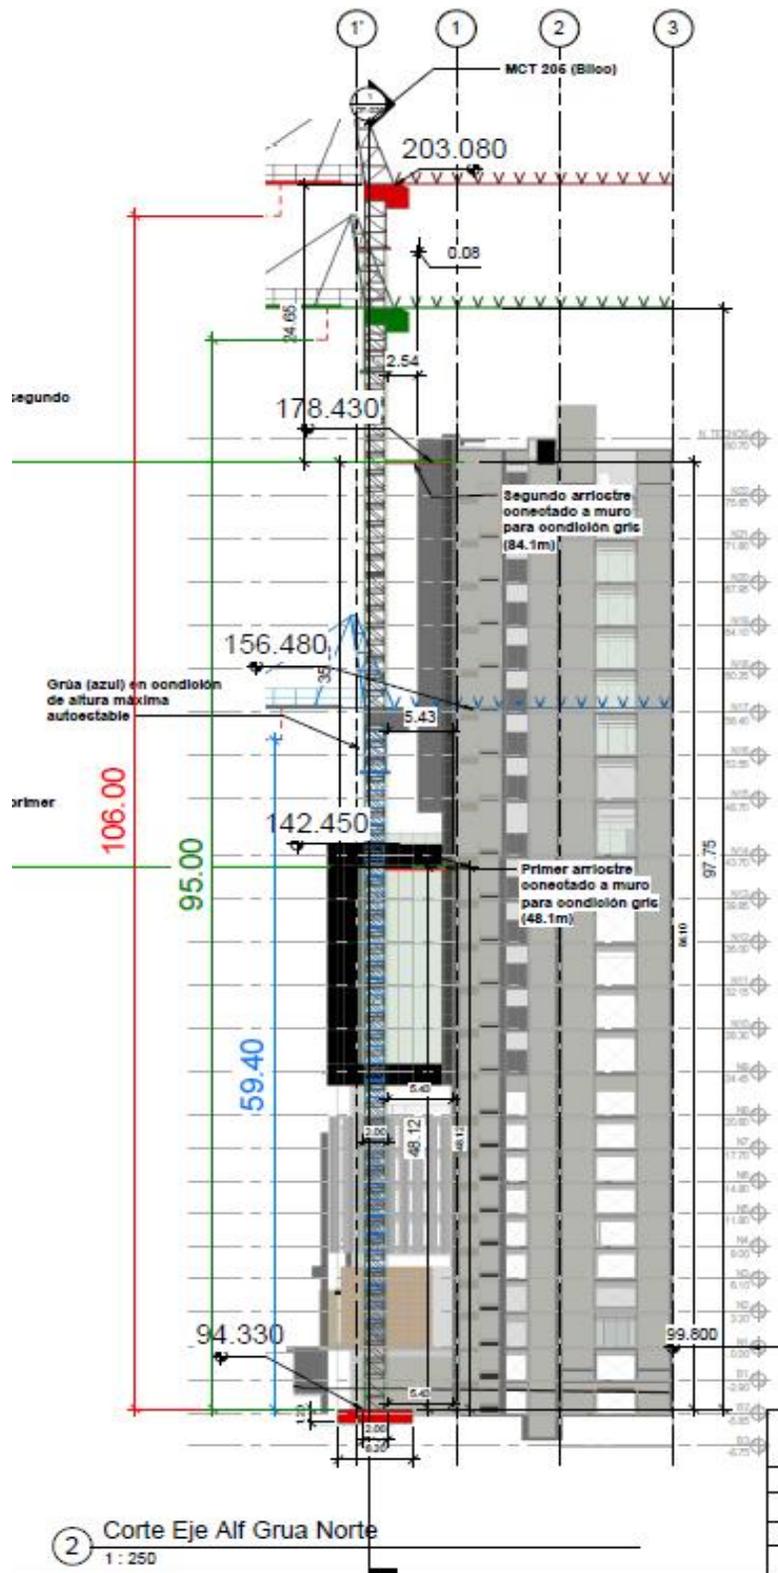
Elevación Oeste de Torre Universal Fase 1.
